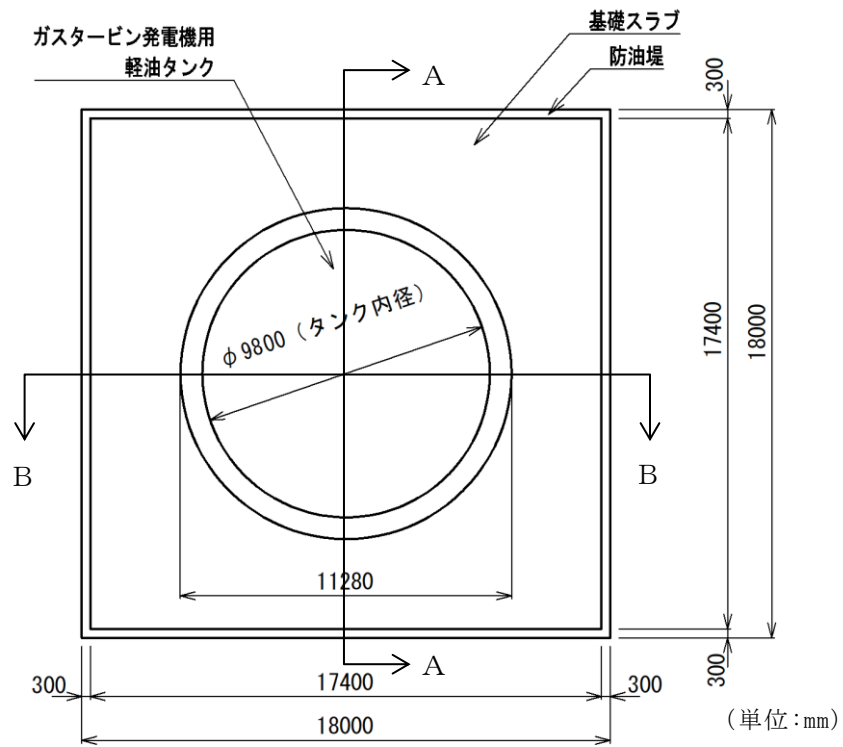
14-2 ガスタービン発電機用軽油タンク基礎 平面図
